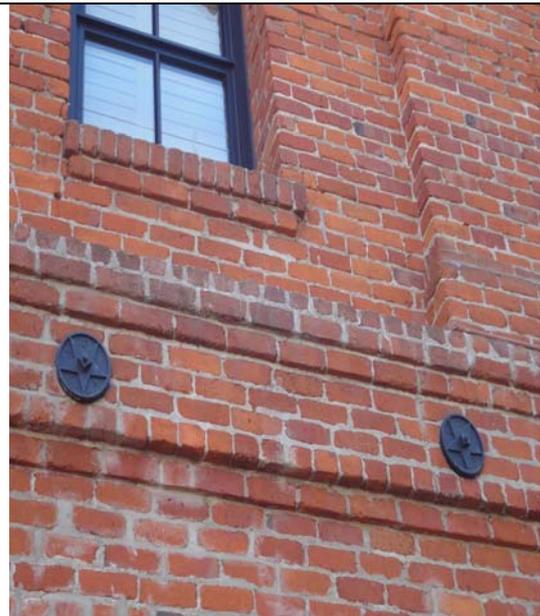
舊金山老舊之磚造建物結構之樑柱履見用 ANCHOR 加強情形
